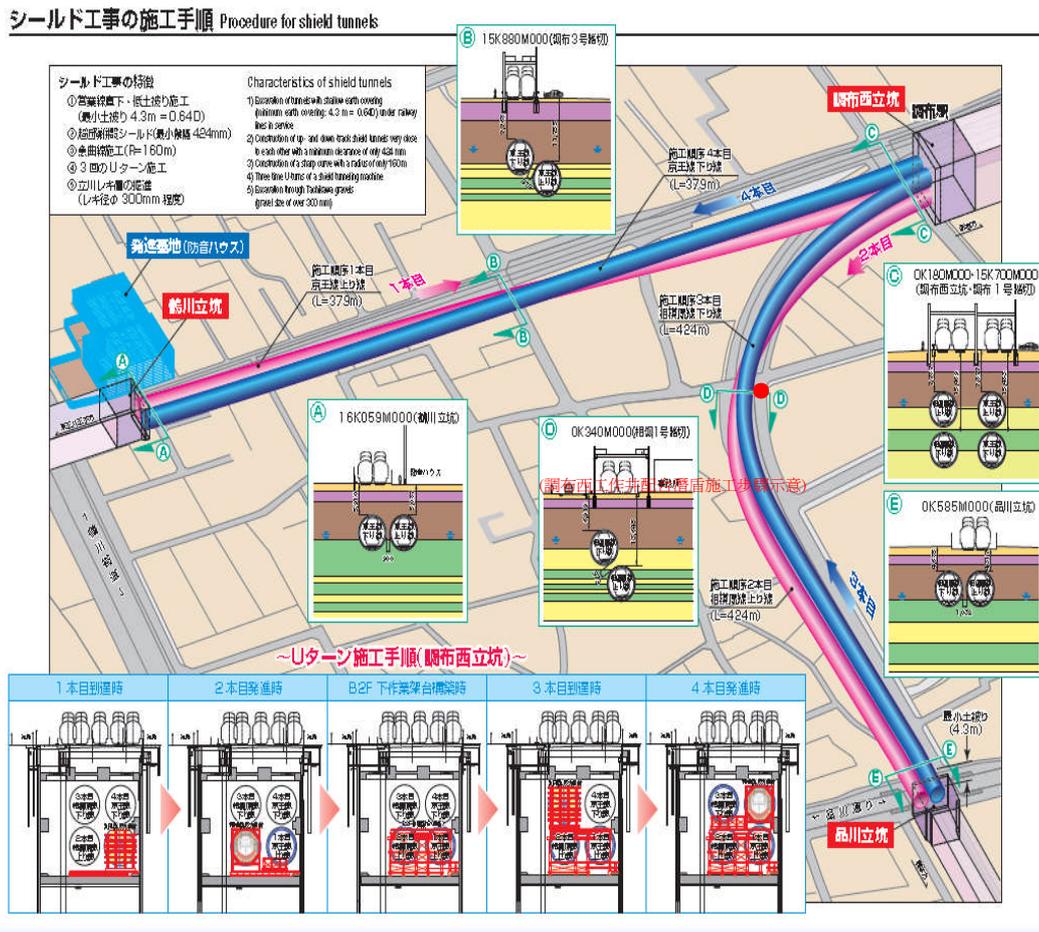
調布市鐵路立體化第四工區潛盾施工計畫平面圖
